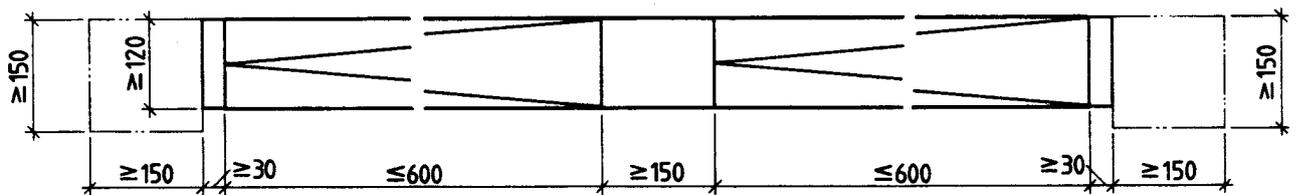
Rampe (Rampenlänge ≥ 600 cm)
